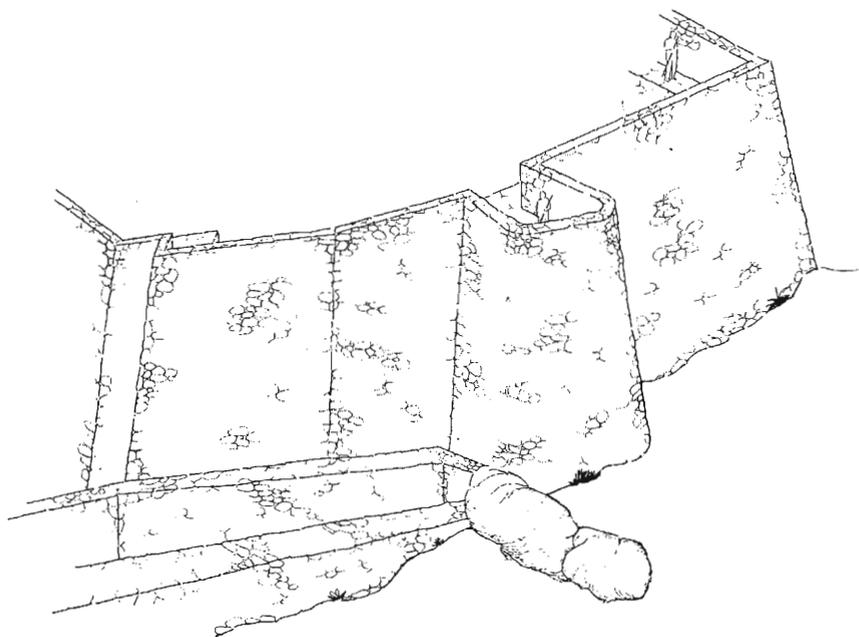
Reconstrucción hipotética de la muralla vista zona norte (J. M. Subirats).
